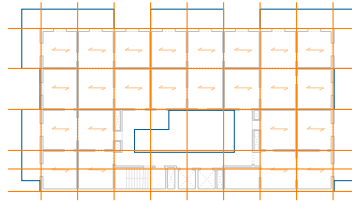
Pórticos de acero en planta baja del caso 06. 21 viviendas de Protección Oficial
